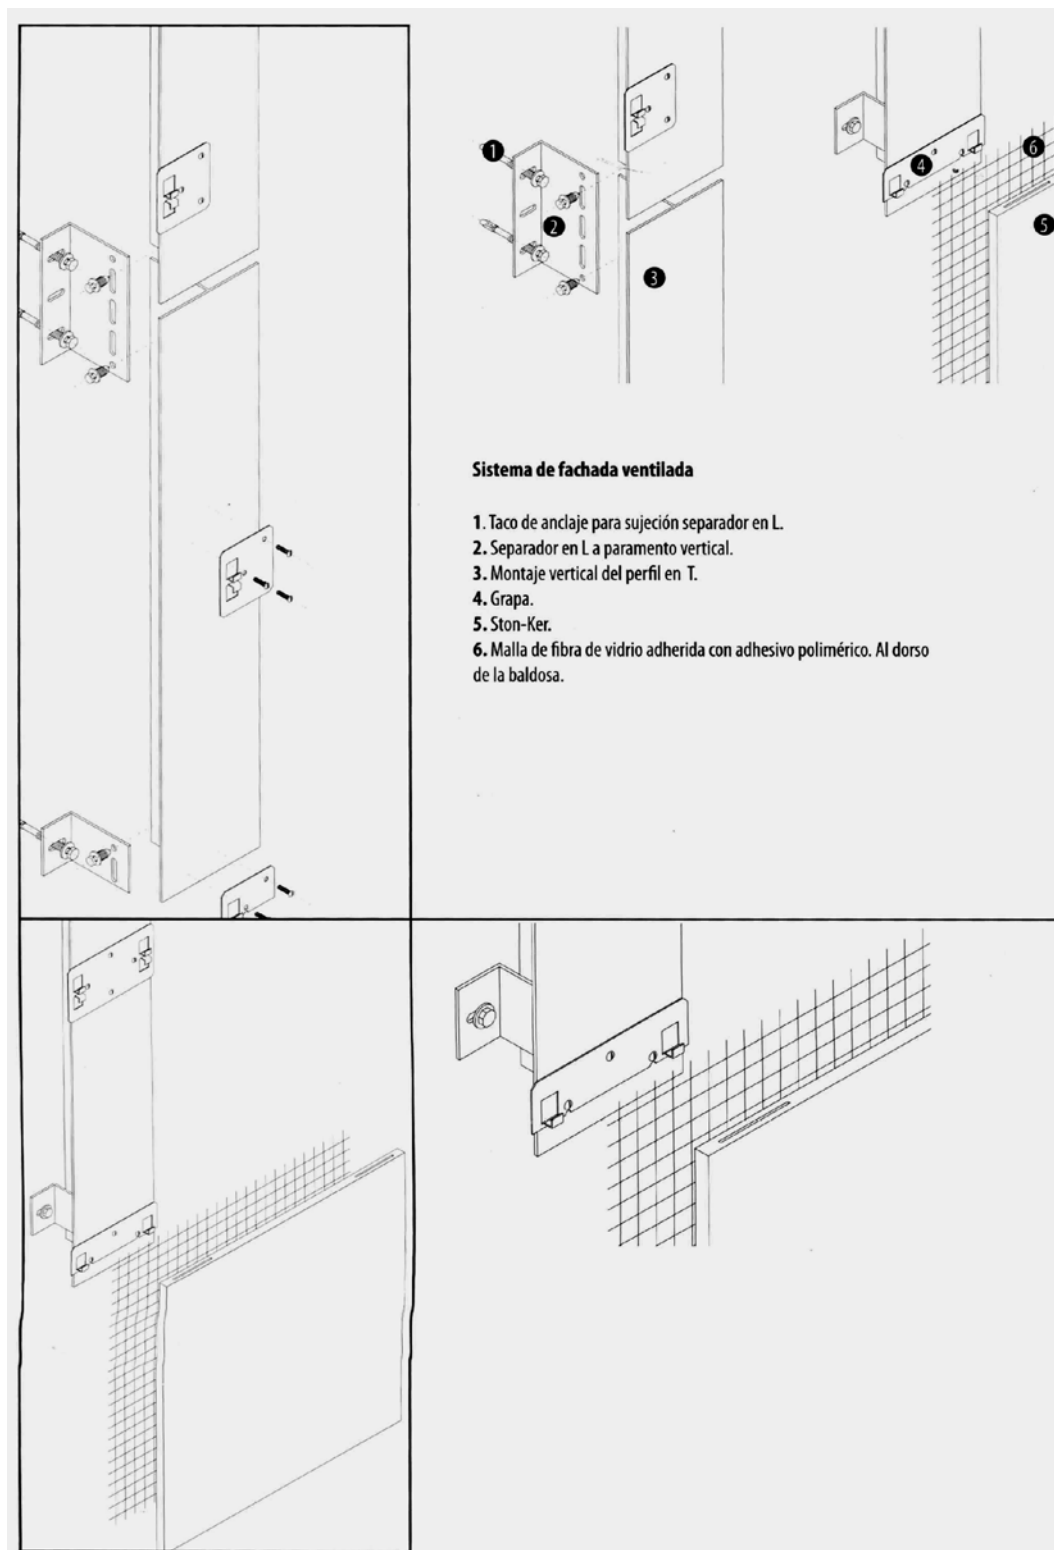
Detalle constructivo montaje fachada ventilada de juntas abiertas objeto de estudio
